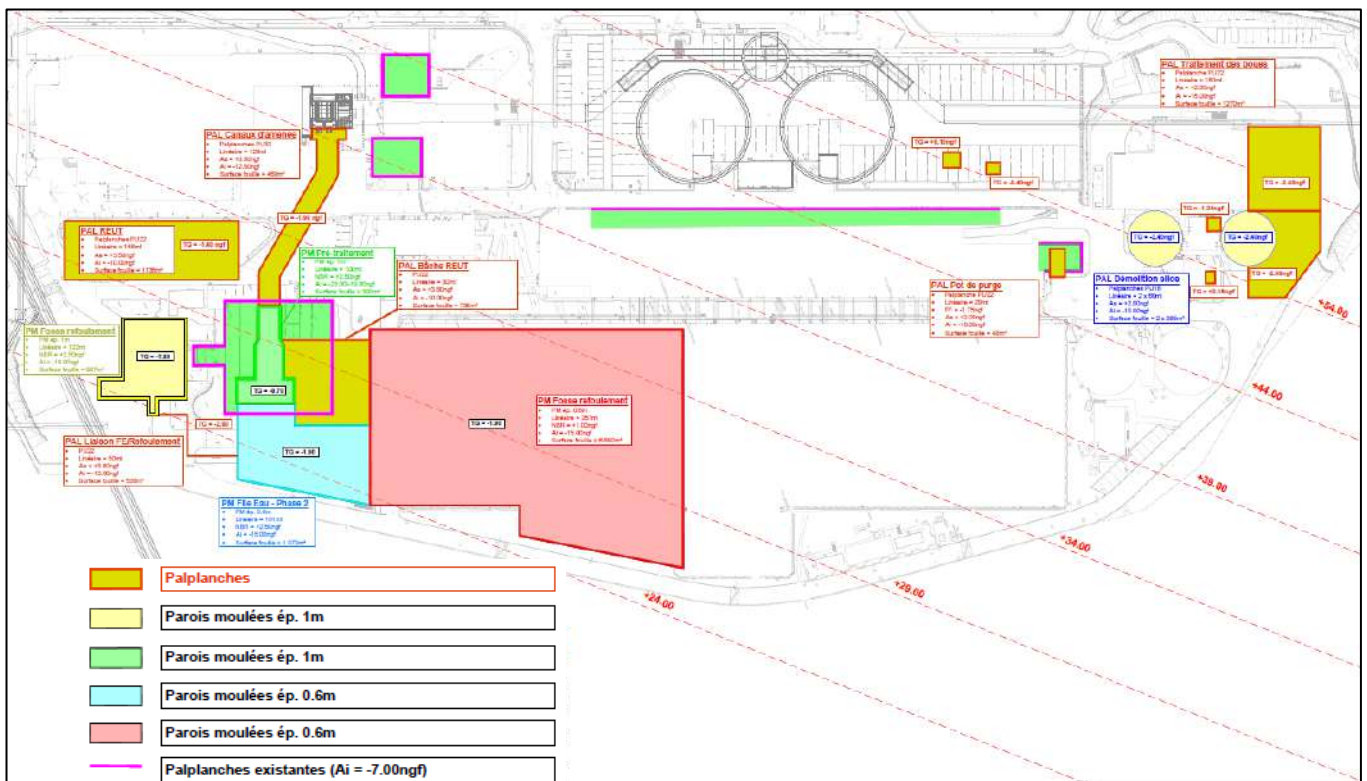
Localisation des palplanches et parois moulées en situation projetée
